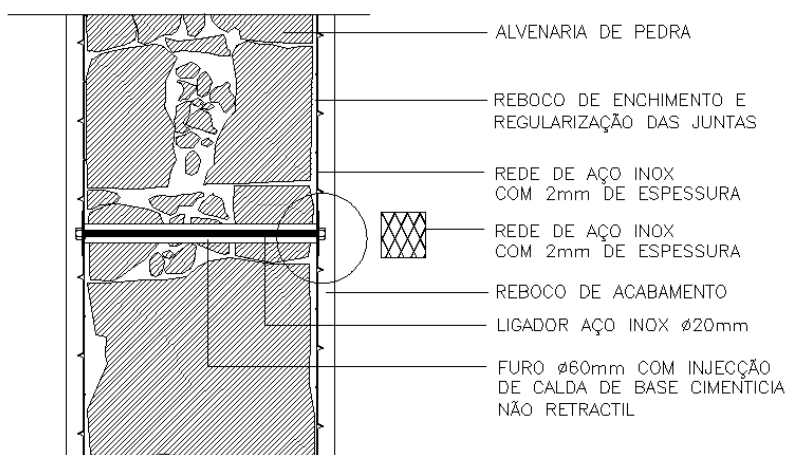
Corte vertical do pormenor de reforço das paredes com estrutura metálica, na zona da parede exterior [31].
